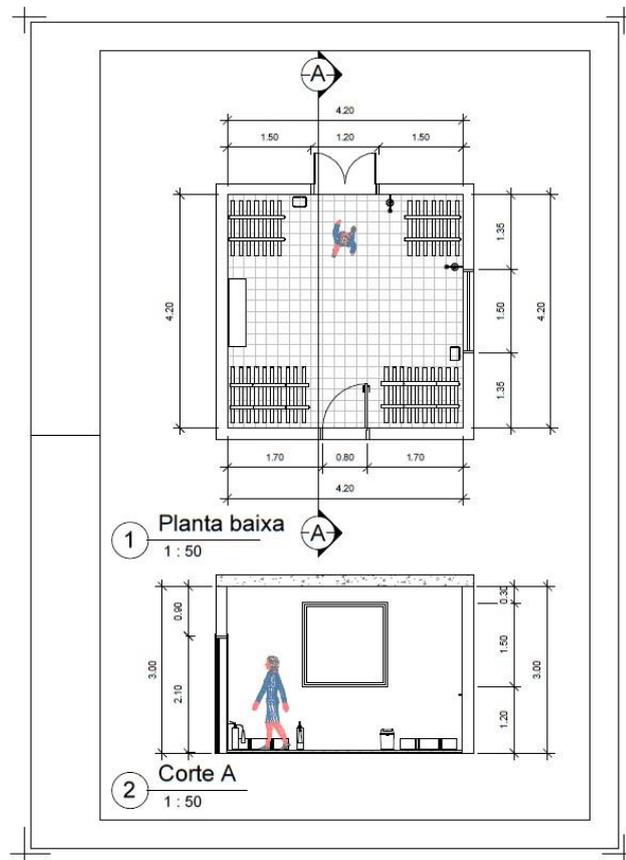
Planta baixa e corte transversal (corte A) da sala de armazenamento de resíduos.
